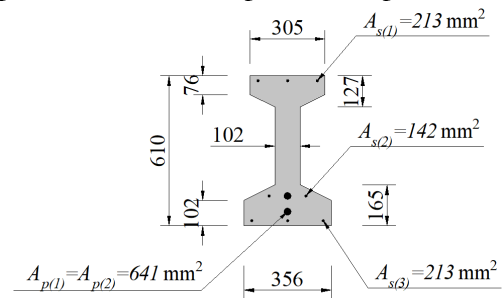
Sección de las vigas ensayadas por Breckenridge y Bugg [14].
